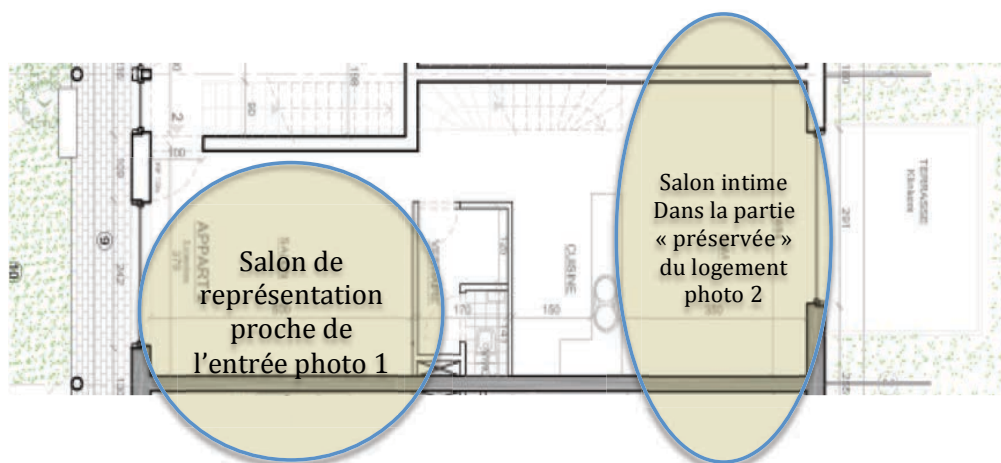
Plan et salons : « de représentation », photo à gauche, et « intime », photo à droite, logement de M. Fadel, habitant de « la rue Fin », plan du concepteur et photos Eric RUIZ.
